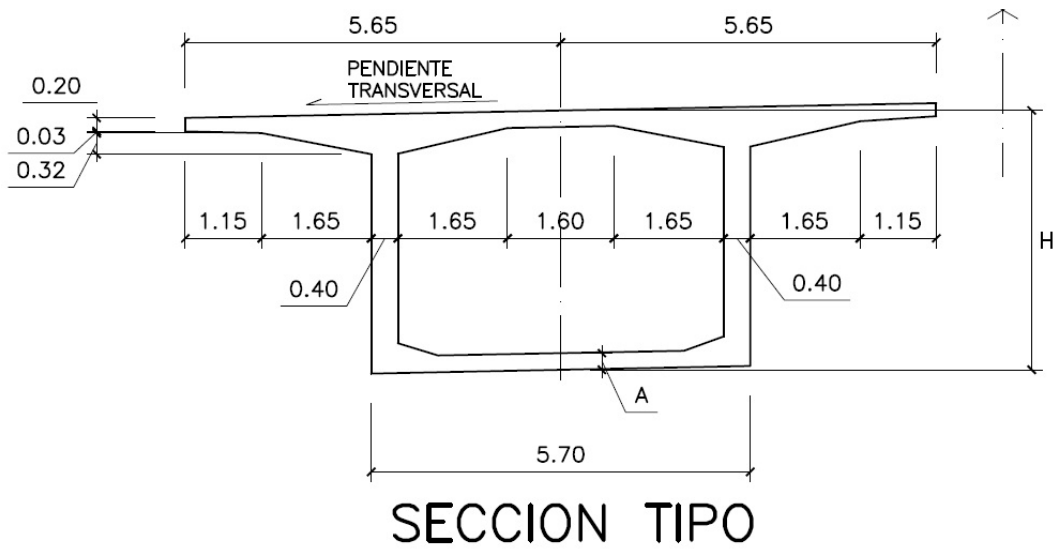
Sección Transversal Típica (Fuente: Puente Chilina, Plan Técnico GRA)
